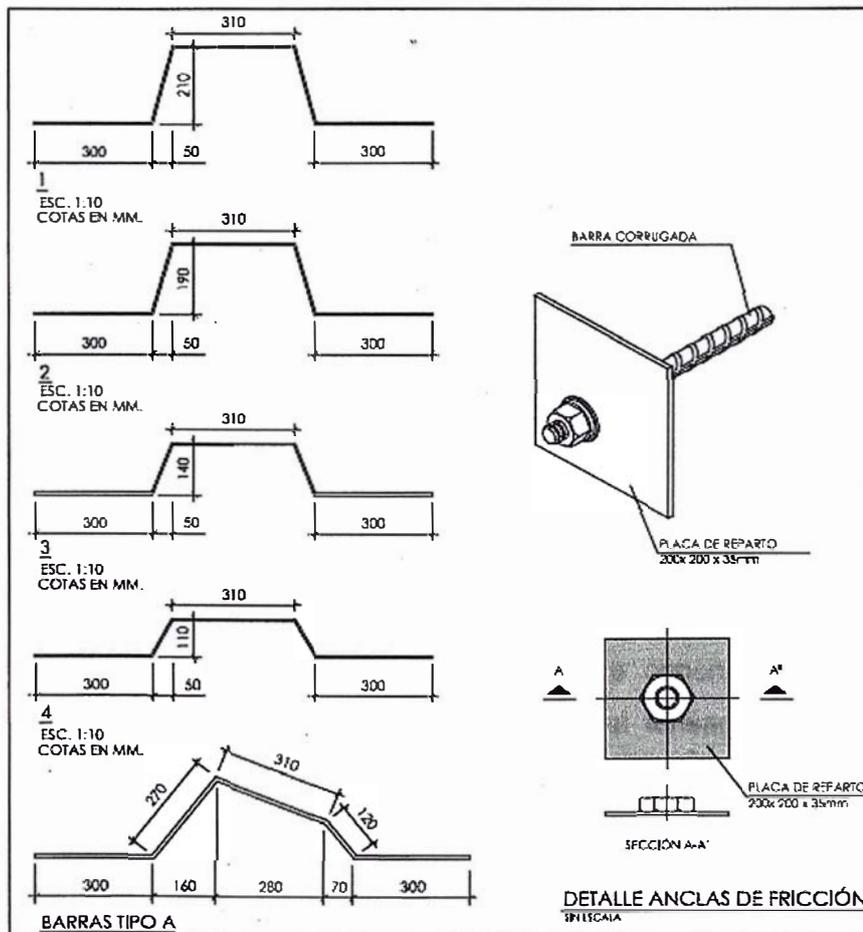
Despiece del acero y placa de reparto en cabezal de anclajes.
